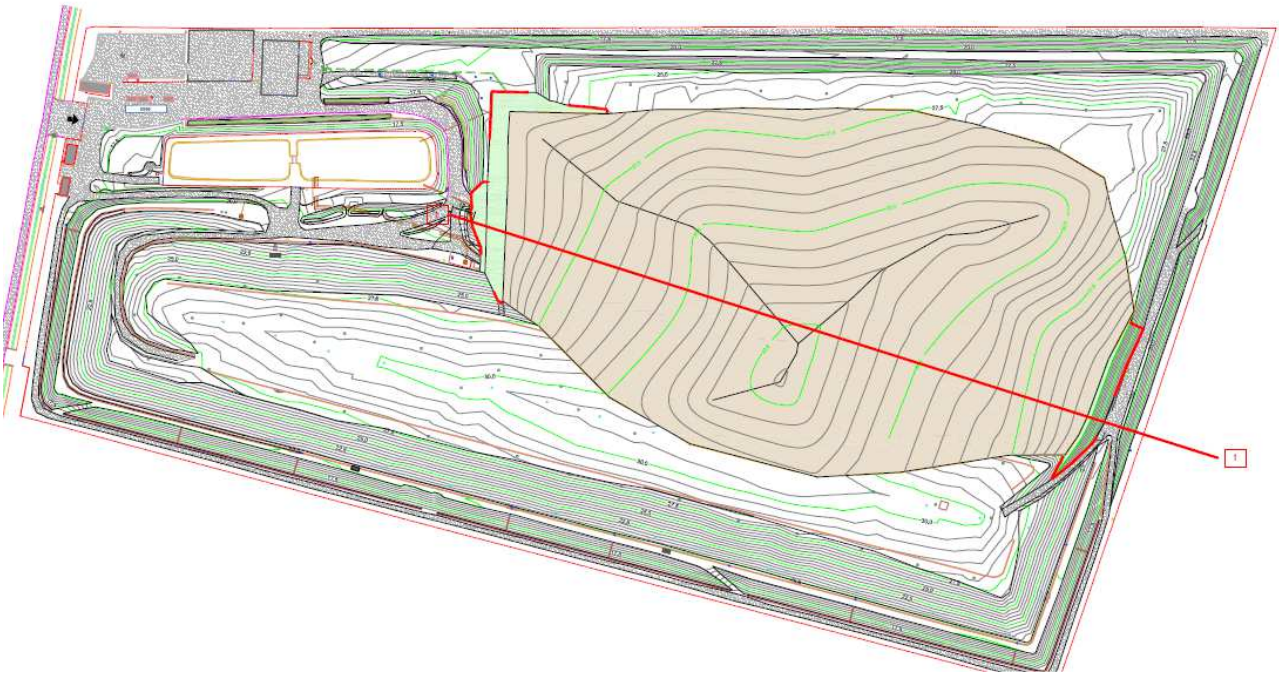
Ubicazione sezione 1 NORD - SUD presa in considerazione nel calcolo dei cedimenti
